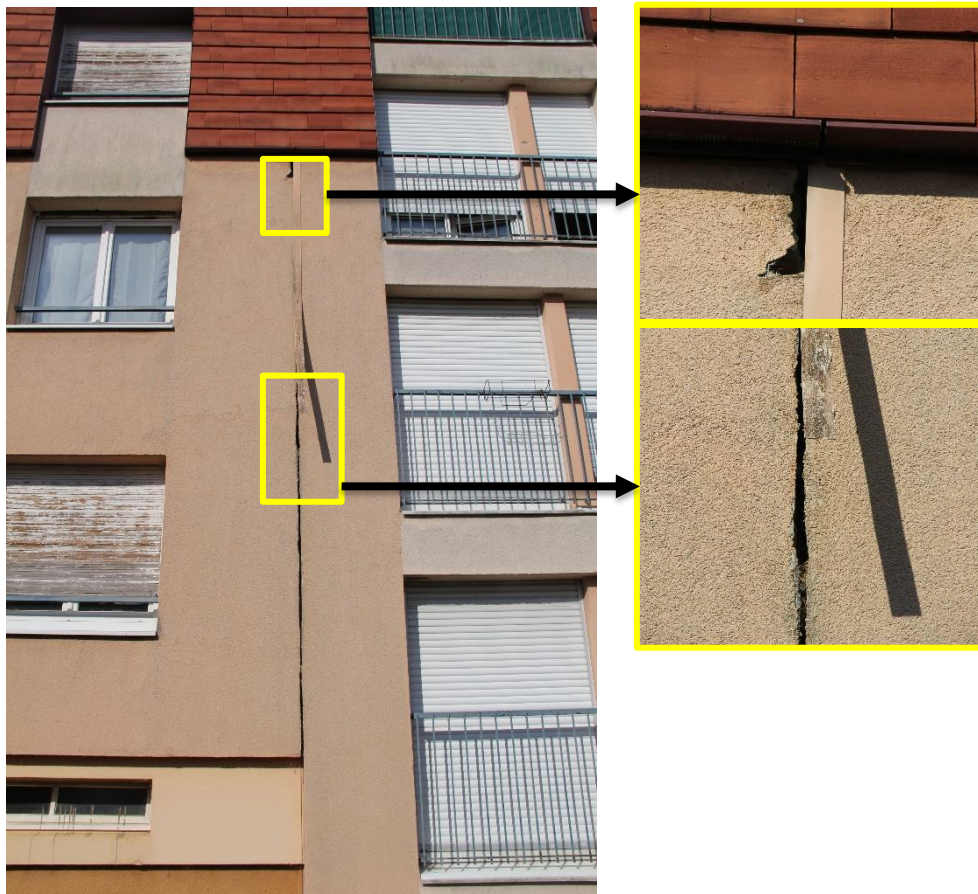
Défaut de maçonnerie, fissure verticale
